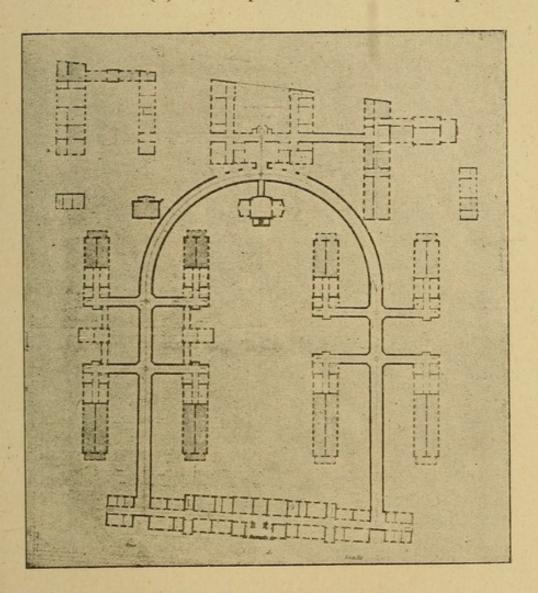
Hopital Boucicaut. - Plan du sous-sol.
